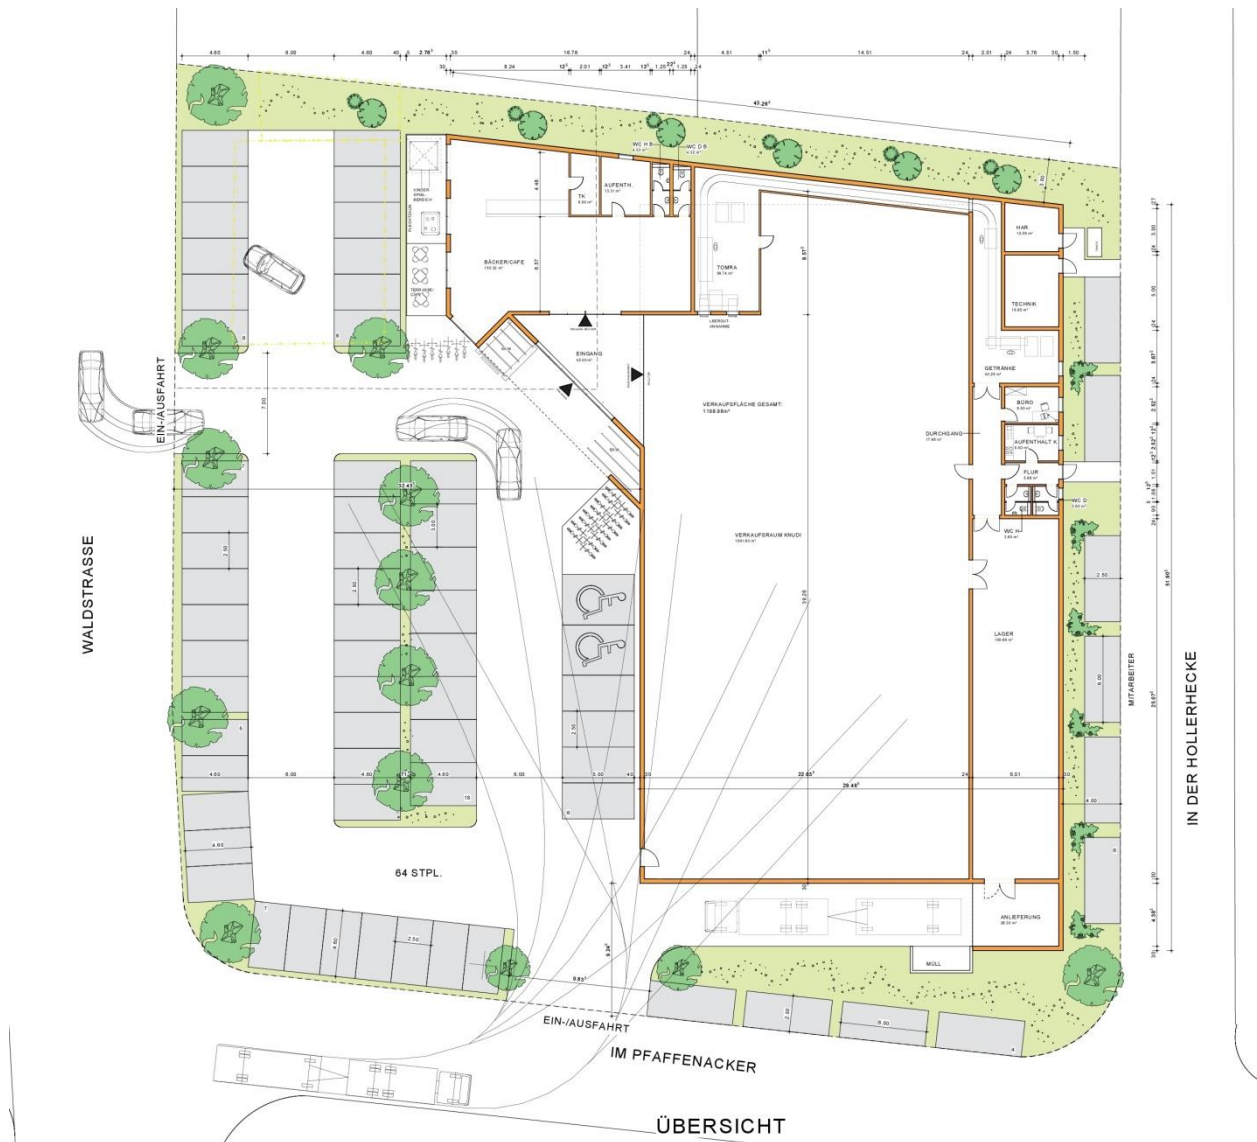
Lageplan zur Vorhabenplanung (Vorentwurf des Planungsbüros Kehl vom April 2016; unmaßstäblich)
